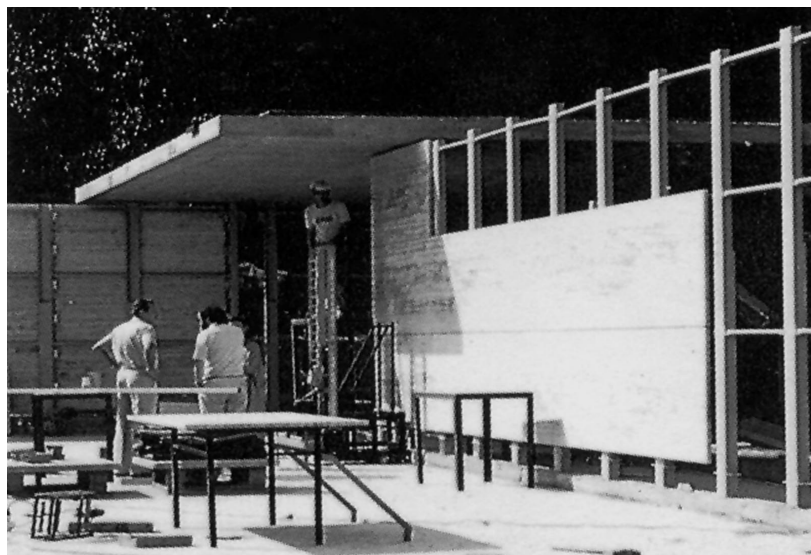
Sistema constructivo utilizado para el travertino del patio. (1986)
